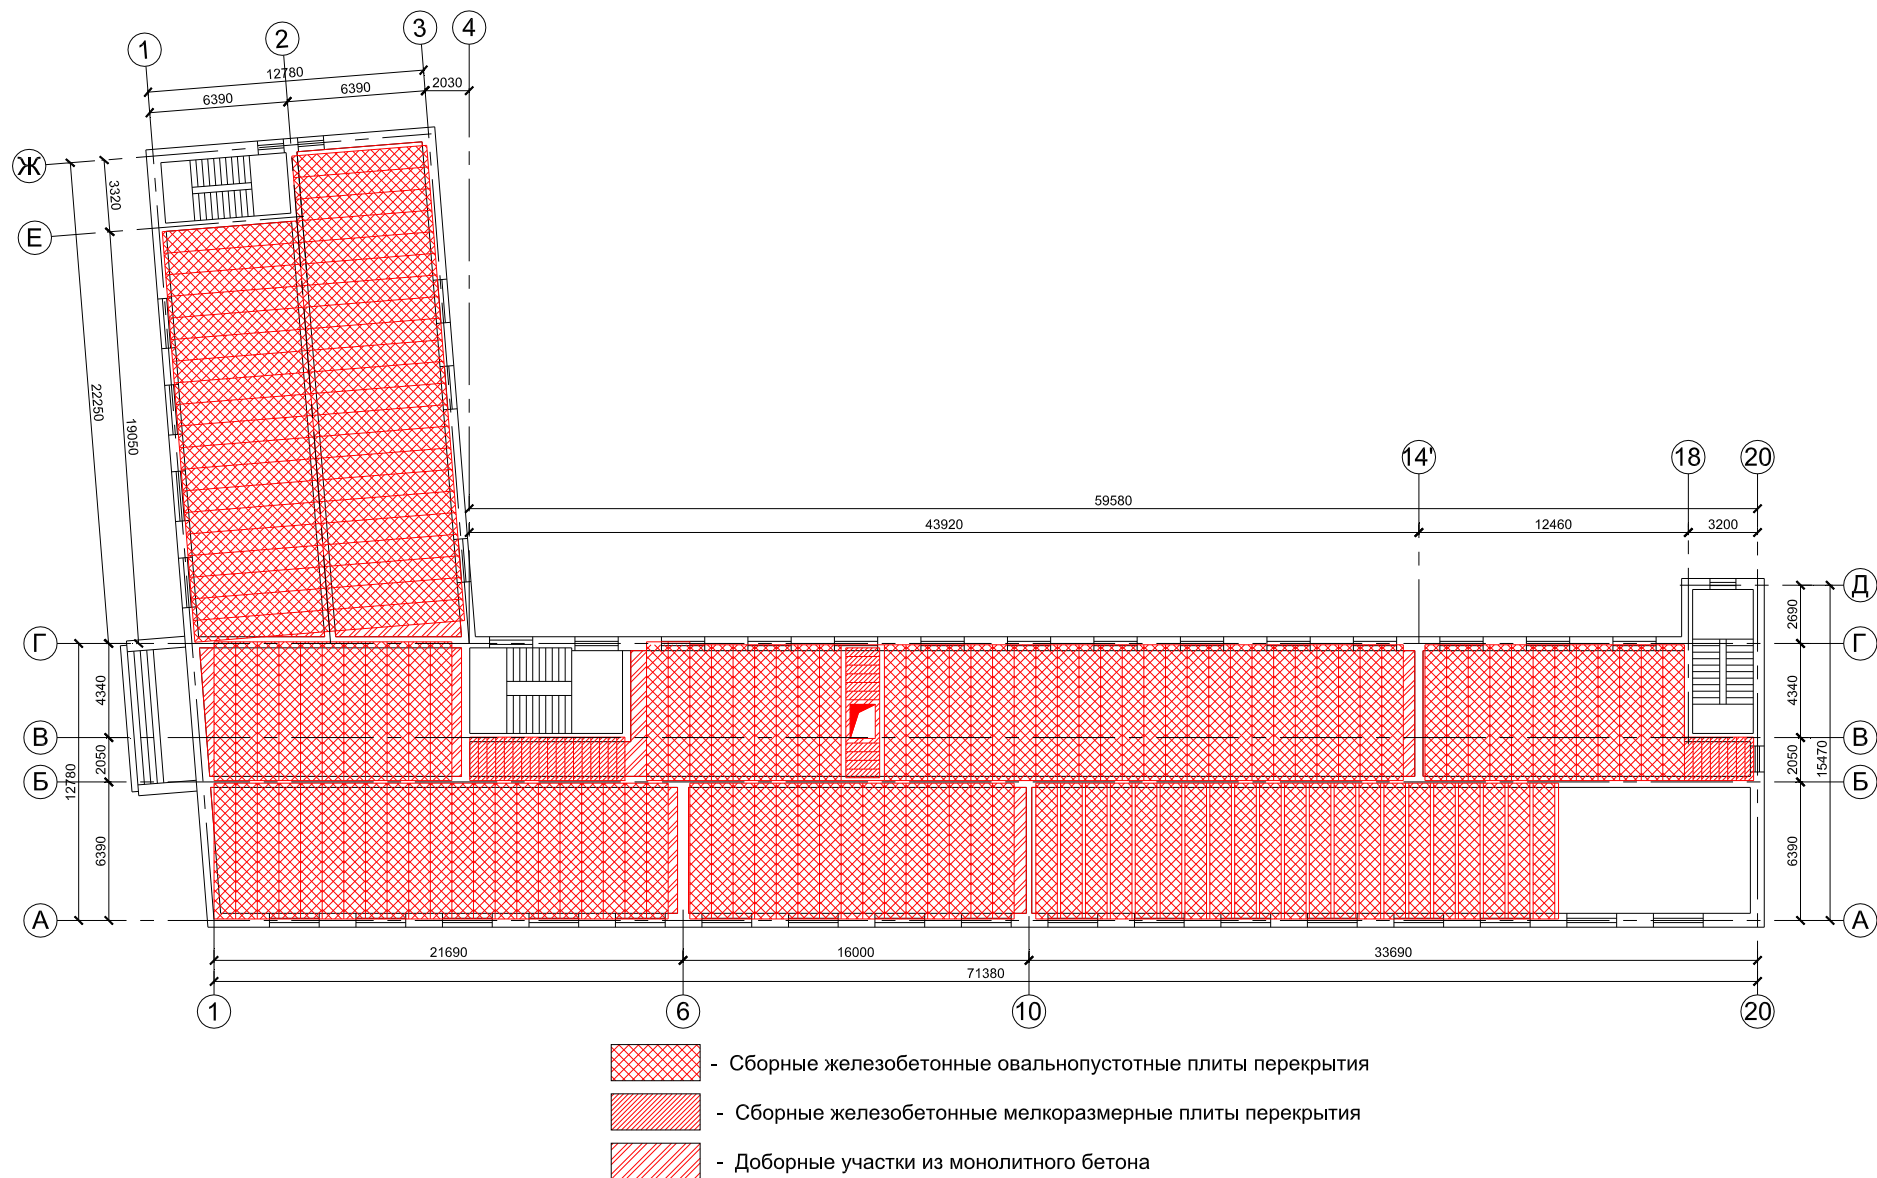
Схема раскладки плит перекрытия над первым этажом здания.
